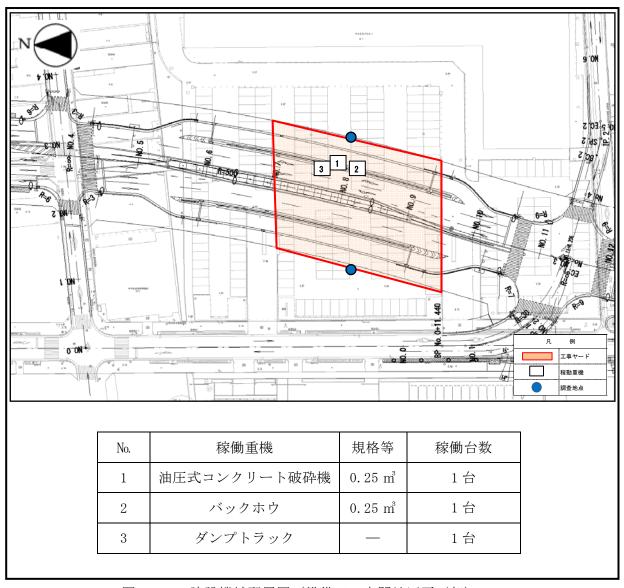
建設機械配置図 (準備工:太閤地区平面部)
